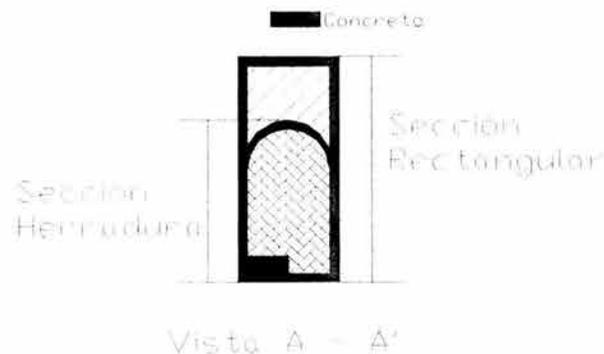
Vista de Corte A - A' de la Galería de Drenaje.
